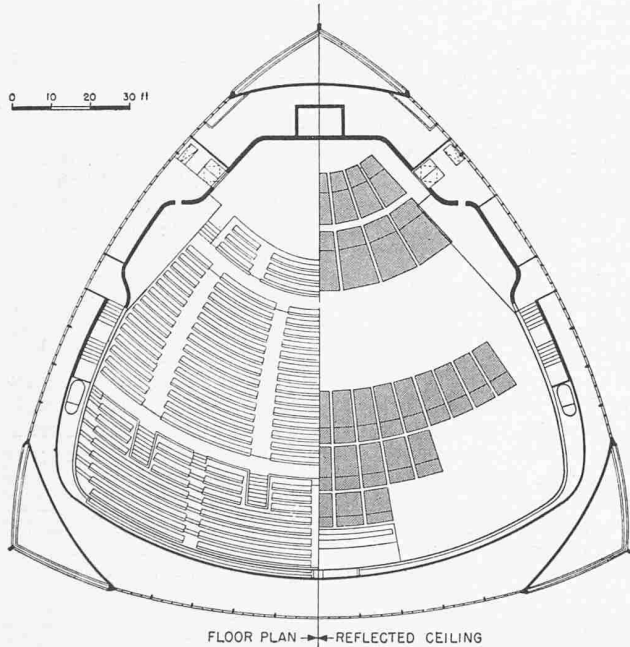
MIT-Auditorium, Grundriss 1:550
